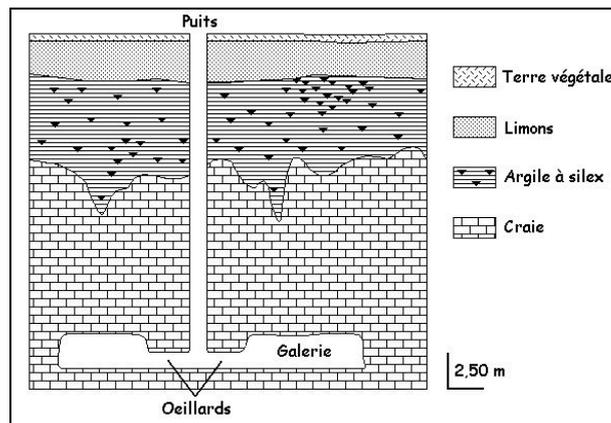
Coupe simplifiée d'une marnière accessible par un puits vertical [Adam et al, ouvrage à paraître]
